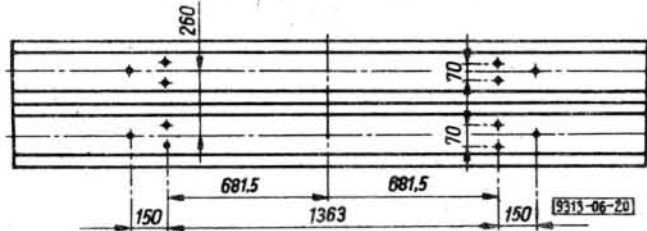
Rozmieszczenie otworów na wkręty w podkładach w przypadku stosowania szyn typu S-41 na podkładkach II/81
